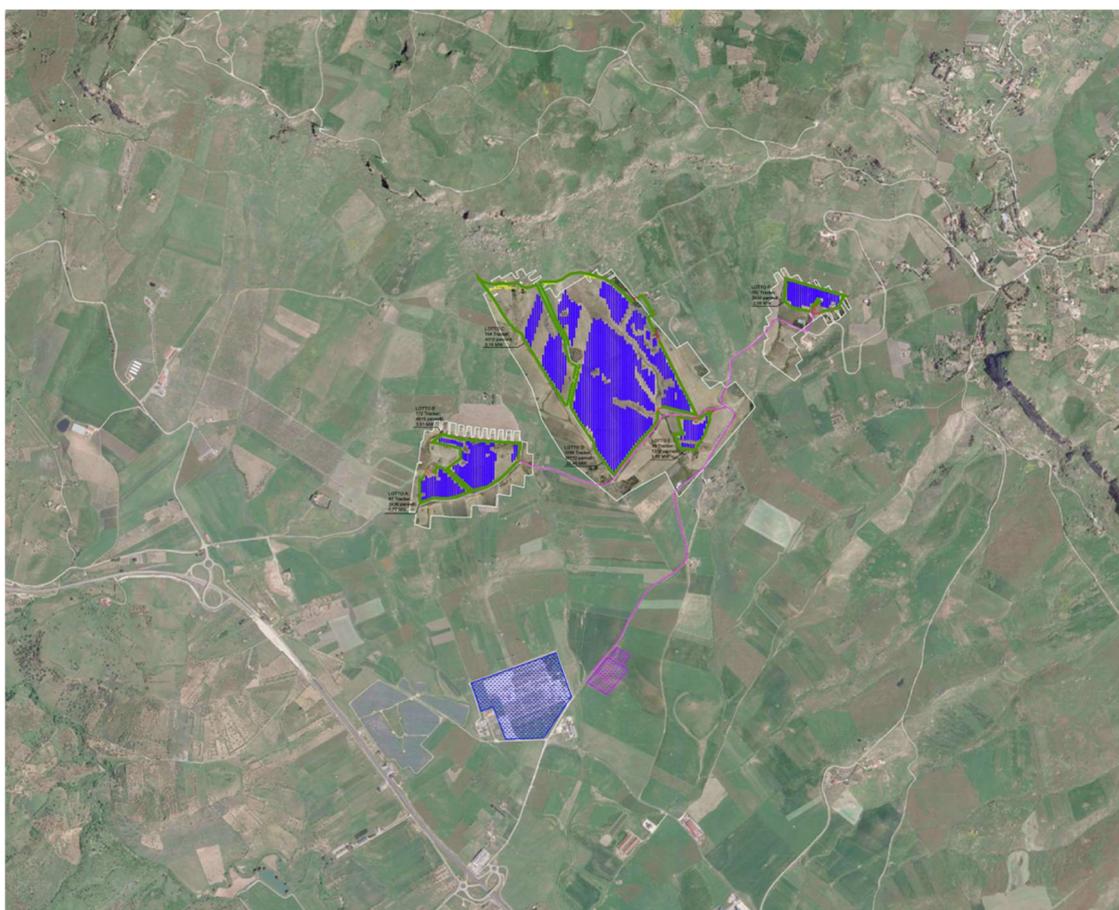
Layout di progetto su ortofoto e su rilievo con drone
